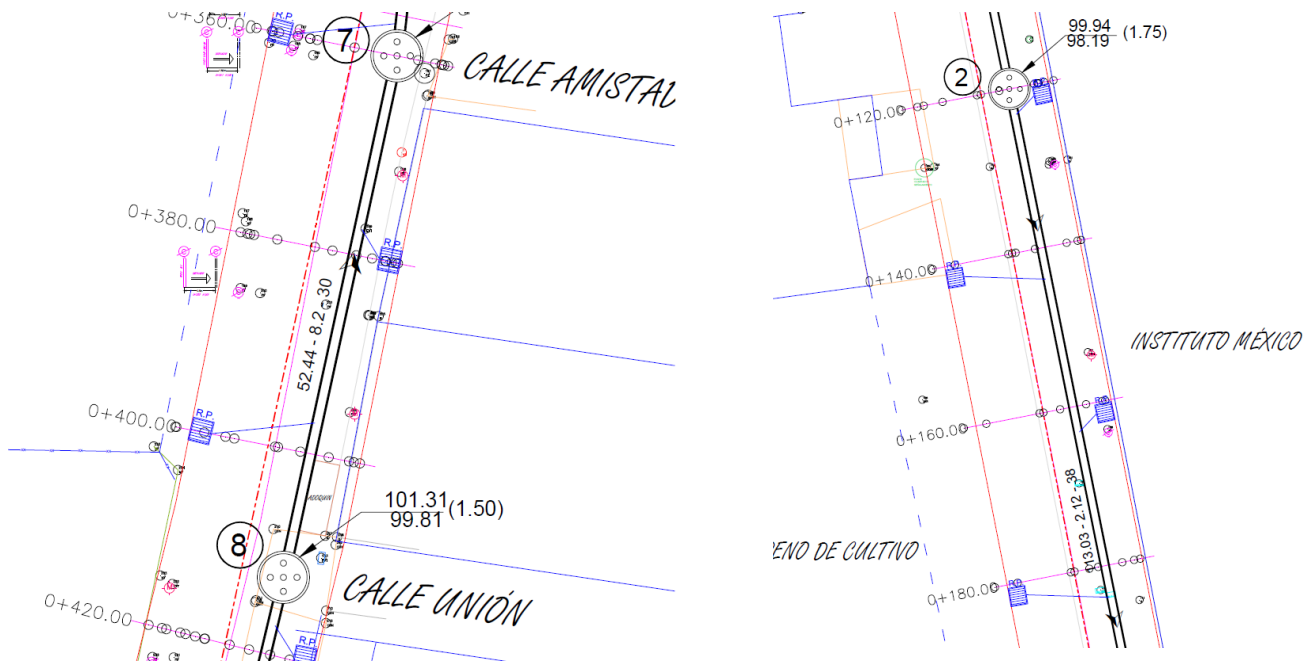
Fragmentos de planta del drenaje pluvial, donde se observan los dos diámetros proyectados para la red, 30cm y 38 cm. Fuente: (Departamento de proyectos de obra pública.)
